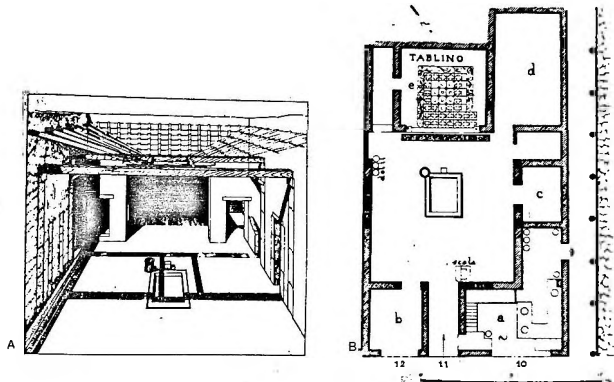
Herculano. Casa anônima a) reconstrução axonométrica do átrio; b) planimetria geral (Vos,1982:291).
